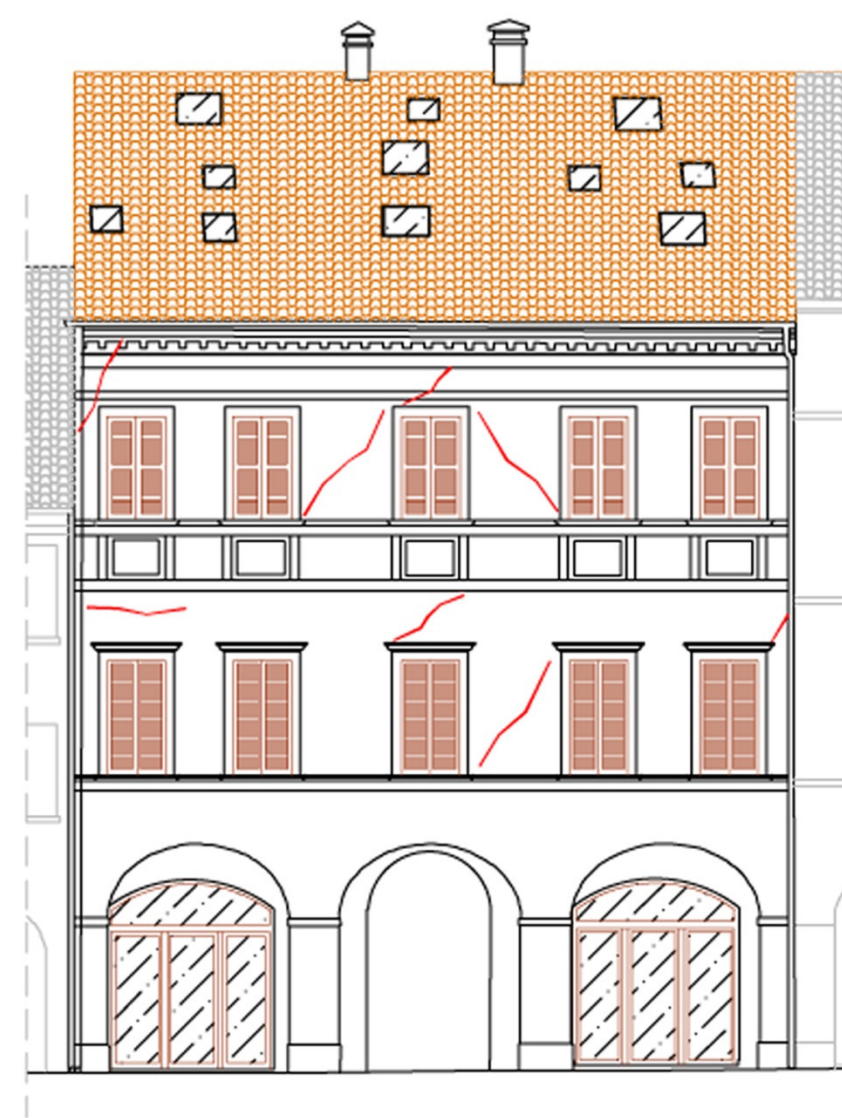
Prospetto su via G. Pico dell'edificio "C"
